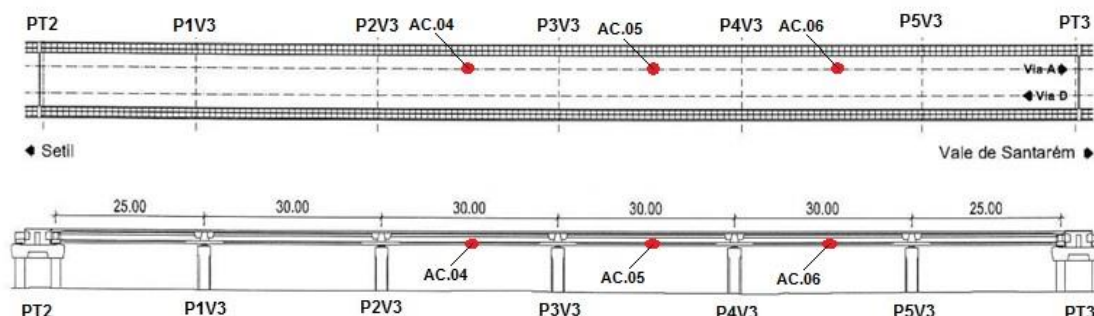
Planta e Corte Longitudinal do módulo V3 [71]
